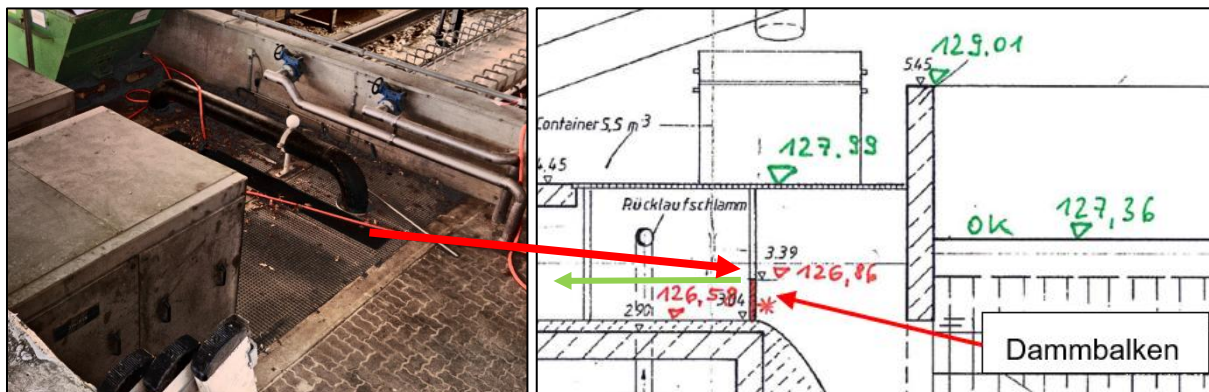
Versetzung der Dammbalkenkonstruktionen
